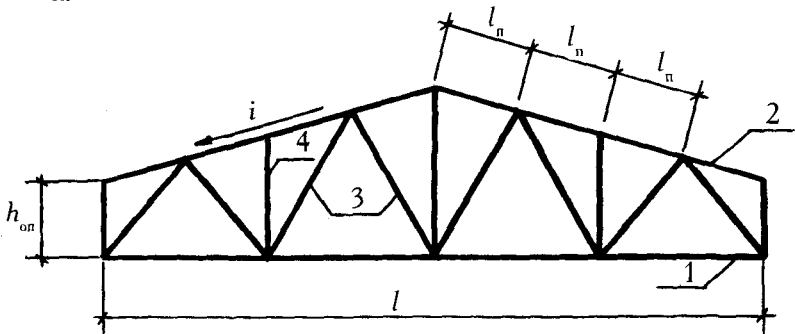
Ферма: 1 — верхний пояс; 2 — нижний пояс; 3 — раскосы; 4 — стойки
